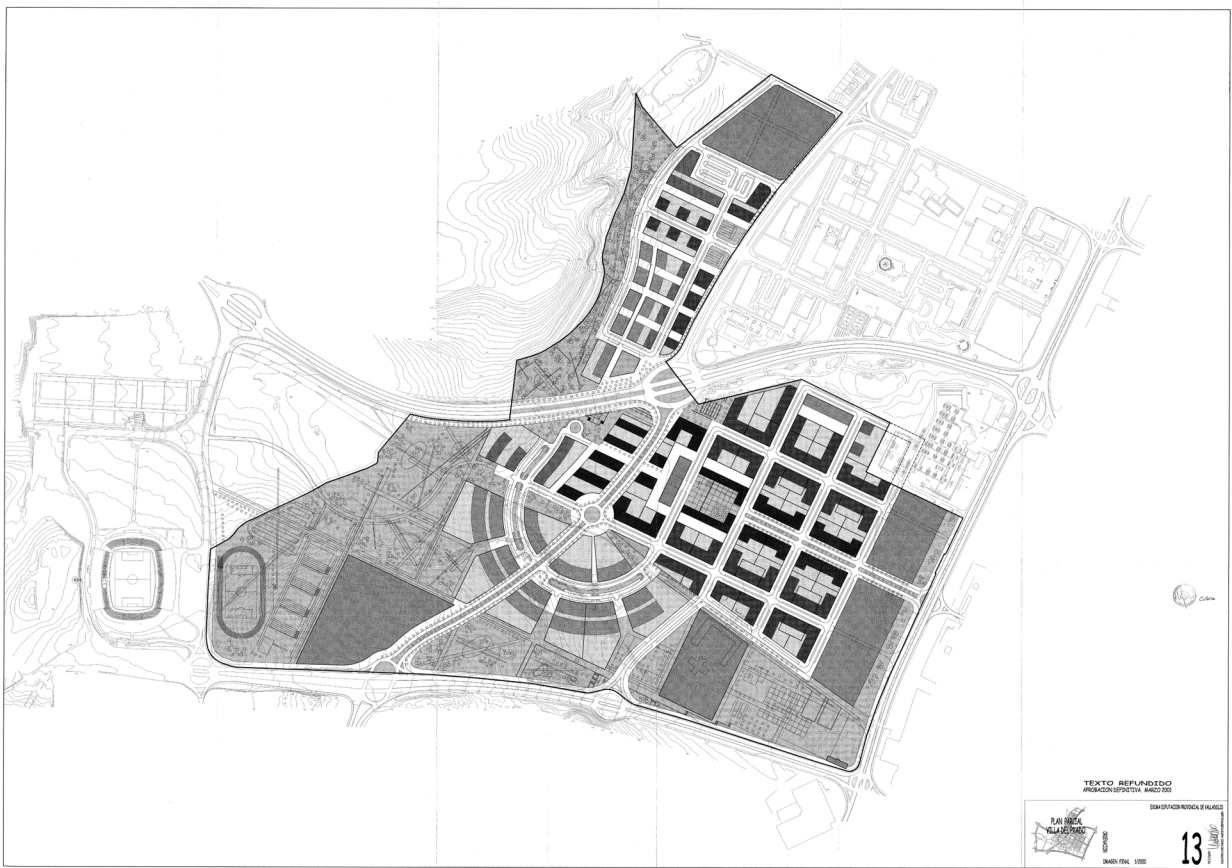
Plan parcial Villa del Prado. Plano de imagen final.
